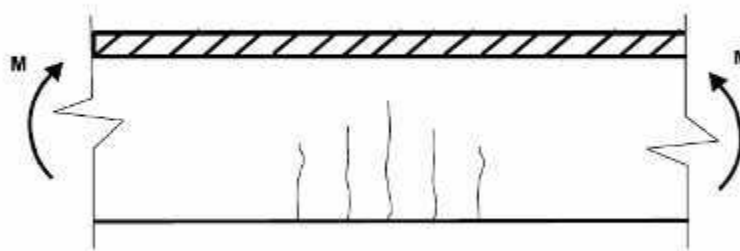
Fissuras ou rupturas por flexão, fonte DNER 1994
